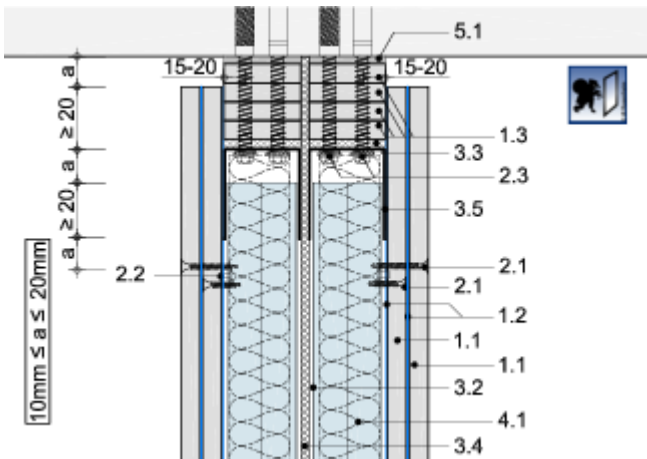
Deckenanschluss Doppelständerwand RC 3 mit erhöhtem Schallschutz
